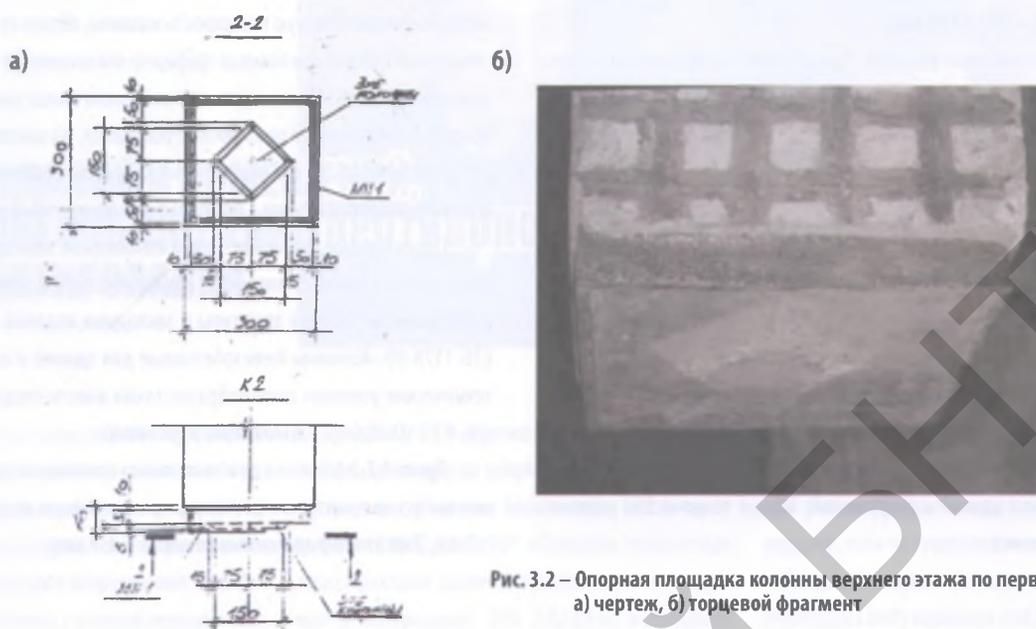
Опорная площадка колонны верхнего этажа по первому варианту: а) чертеж, б) торцевой фрагмент
